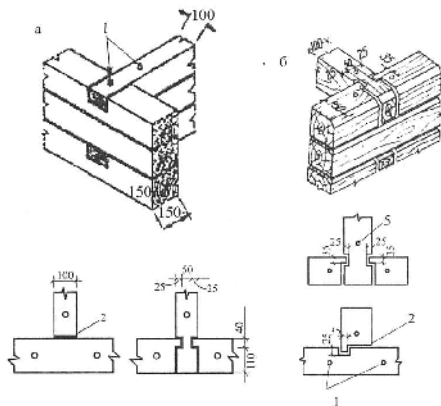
Конструкции внутренних бревенчатых стен: а, б - примыкание внутренней стены к наружной план (а) и общий вид (б); в - стык бревен по длине стены; 1 - мягкий уплотнитель; 2 - обшивная доска; 3 - сквороден; 4 - вставной шип
